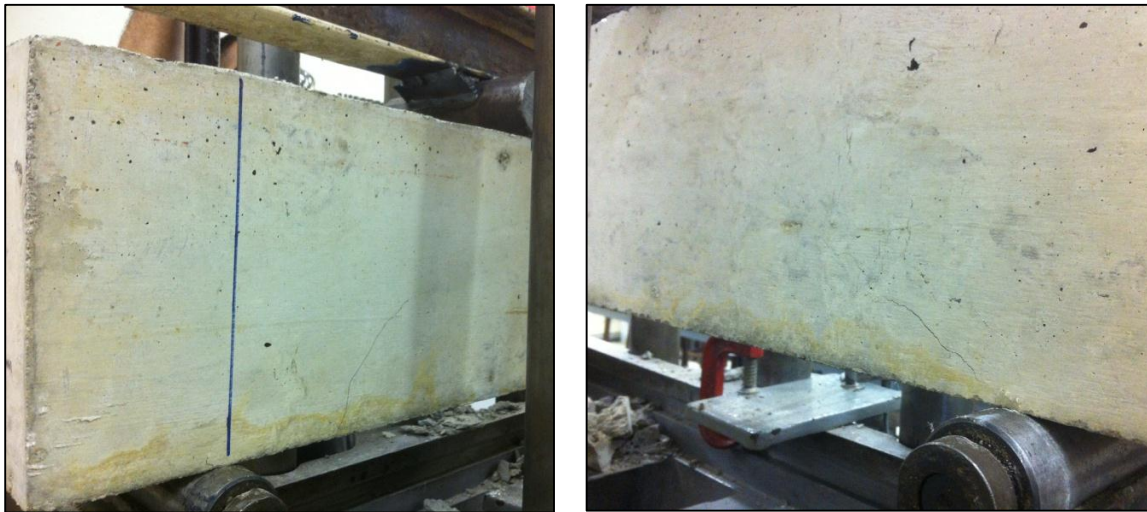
Fissuras nos apoios viga V4.
